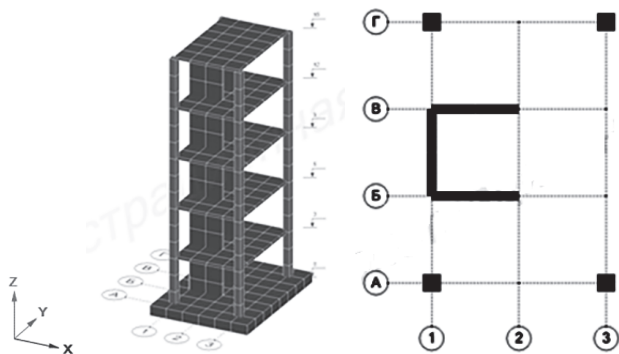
Общий вид расчетной схемы и план типового этажа первого варианта здания (симметричного относительно одной оси)
